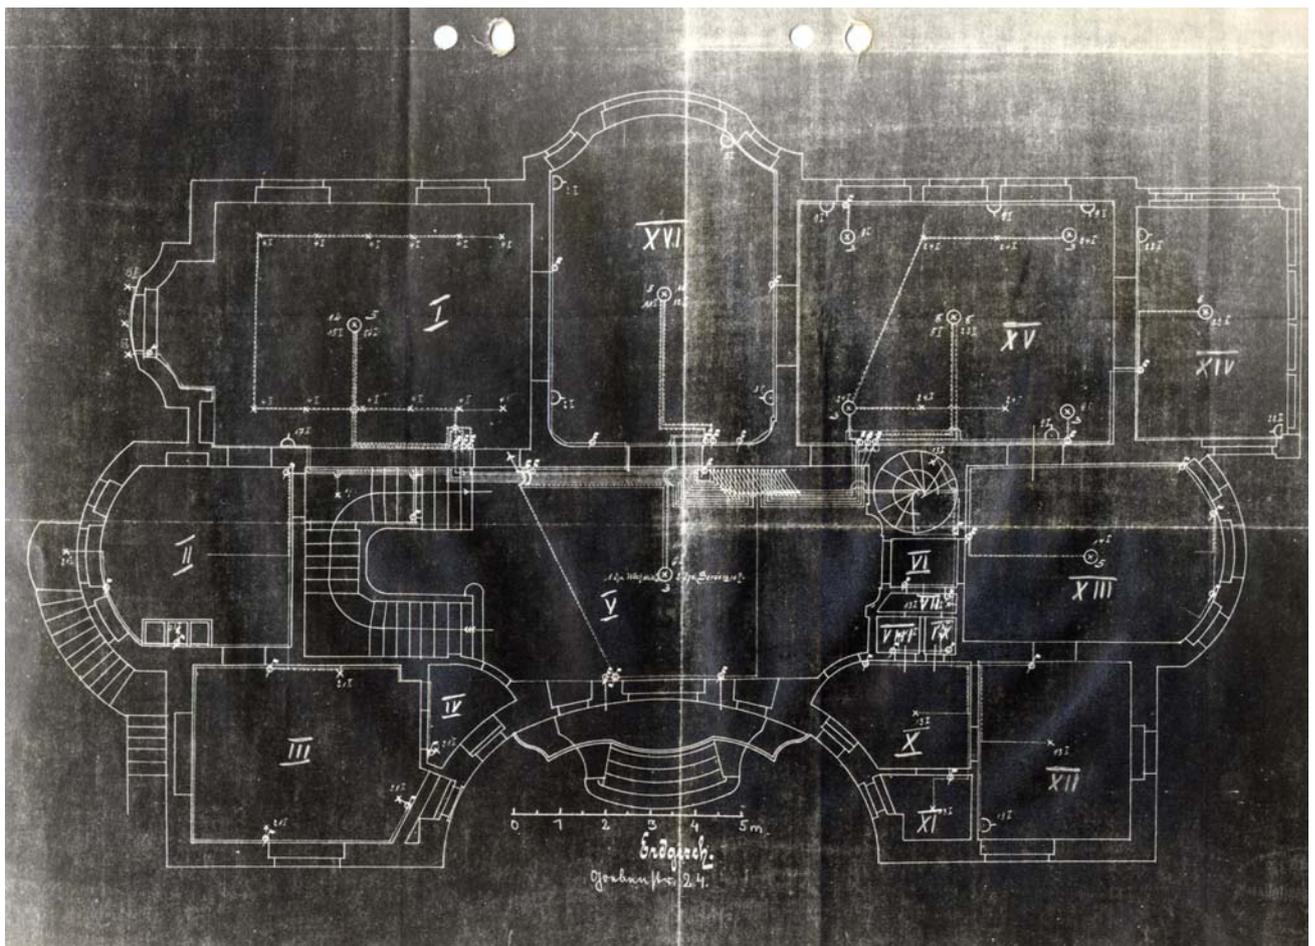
Haus Wichelhaus, Grundriss Erdgeschoss, ohne Jahresangabe, vor 1948
